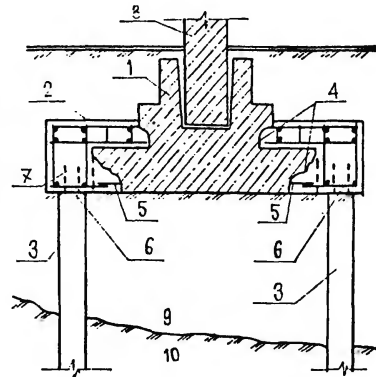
Передача нагрузки от фундамента на железобетонные сваи, погружаемые задавливанием
